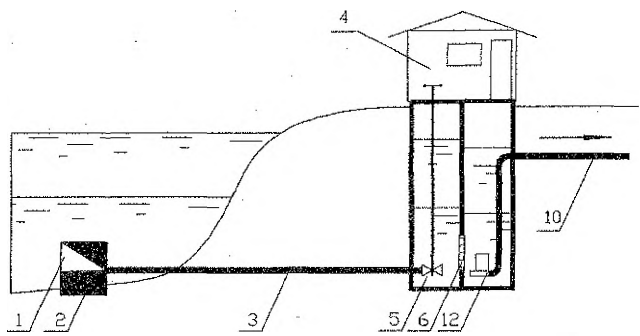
Схема руслового водозабора с «мокрой» установкой насосов
